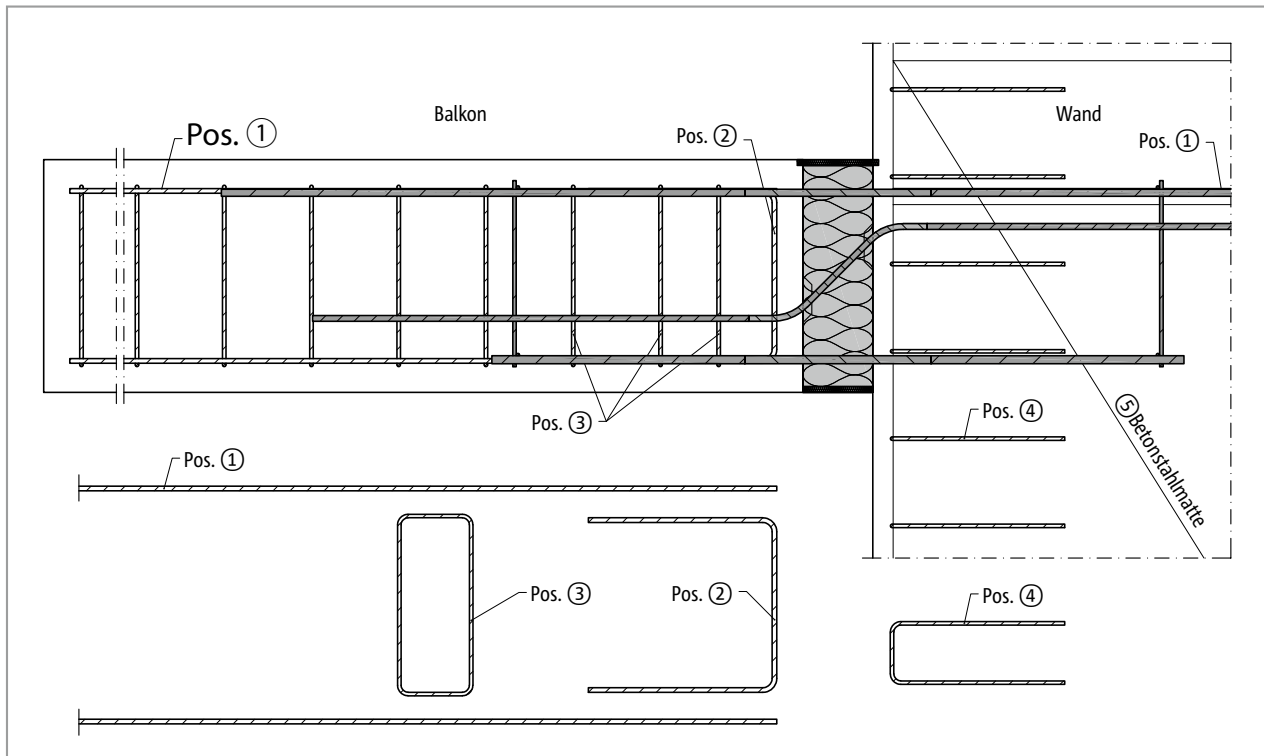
Schöck Isokorb® XT Typ B: Bauseitige Bewehrung
